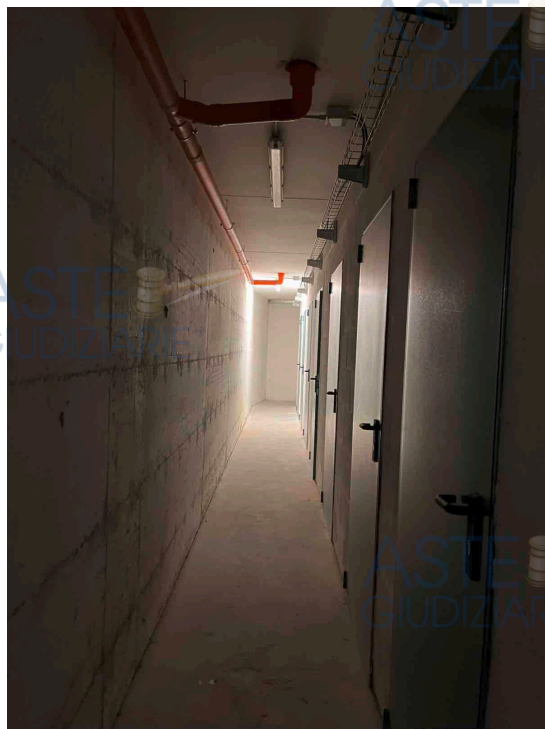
corridoio controterra cantine da n.27 a n. 35 p.S2
